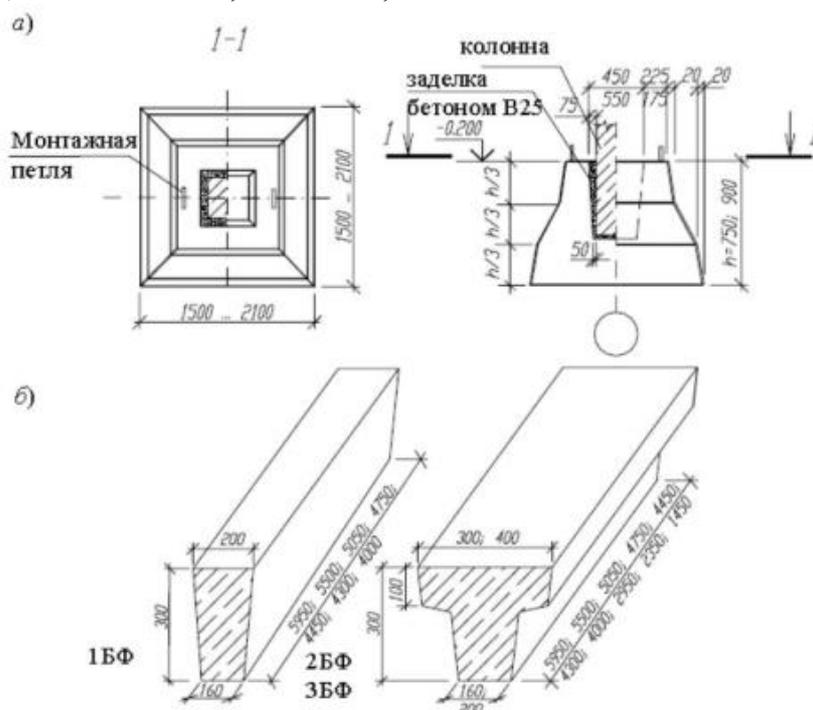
Сборные фундаменты и фундаментные балки каркаса 1.020
